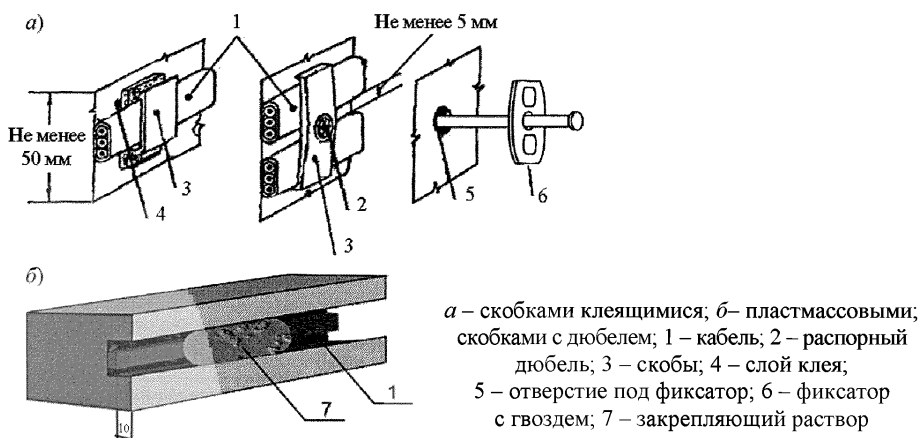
Способы крепления кабеля к строительному основанию
